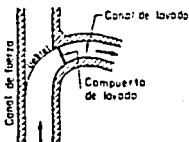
Planta del canal de conducción que muestra la estructura de limpia y desazolve del propio canal.
